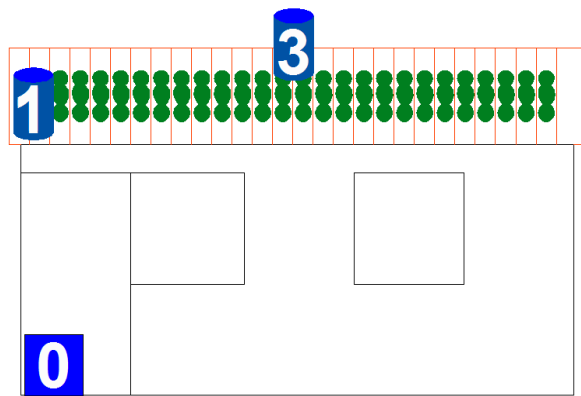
Ubicación acelerómetros. Vivienda Con Techo Verde. Vista: Perfil Fachada Norte
